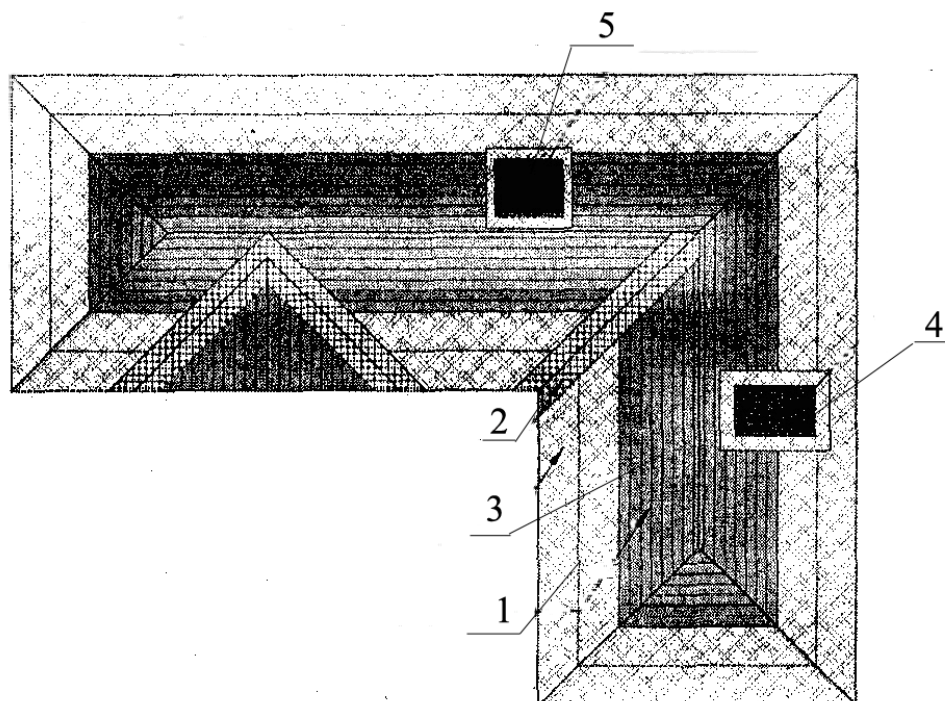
Схема укладки гидроизоляционных пленок:
